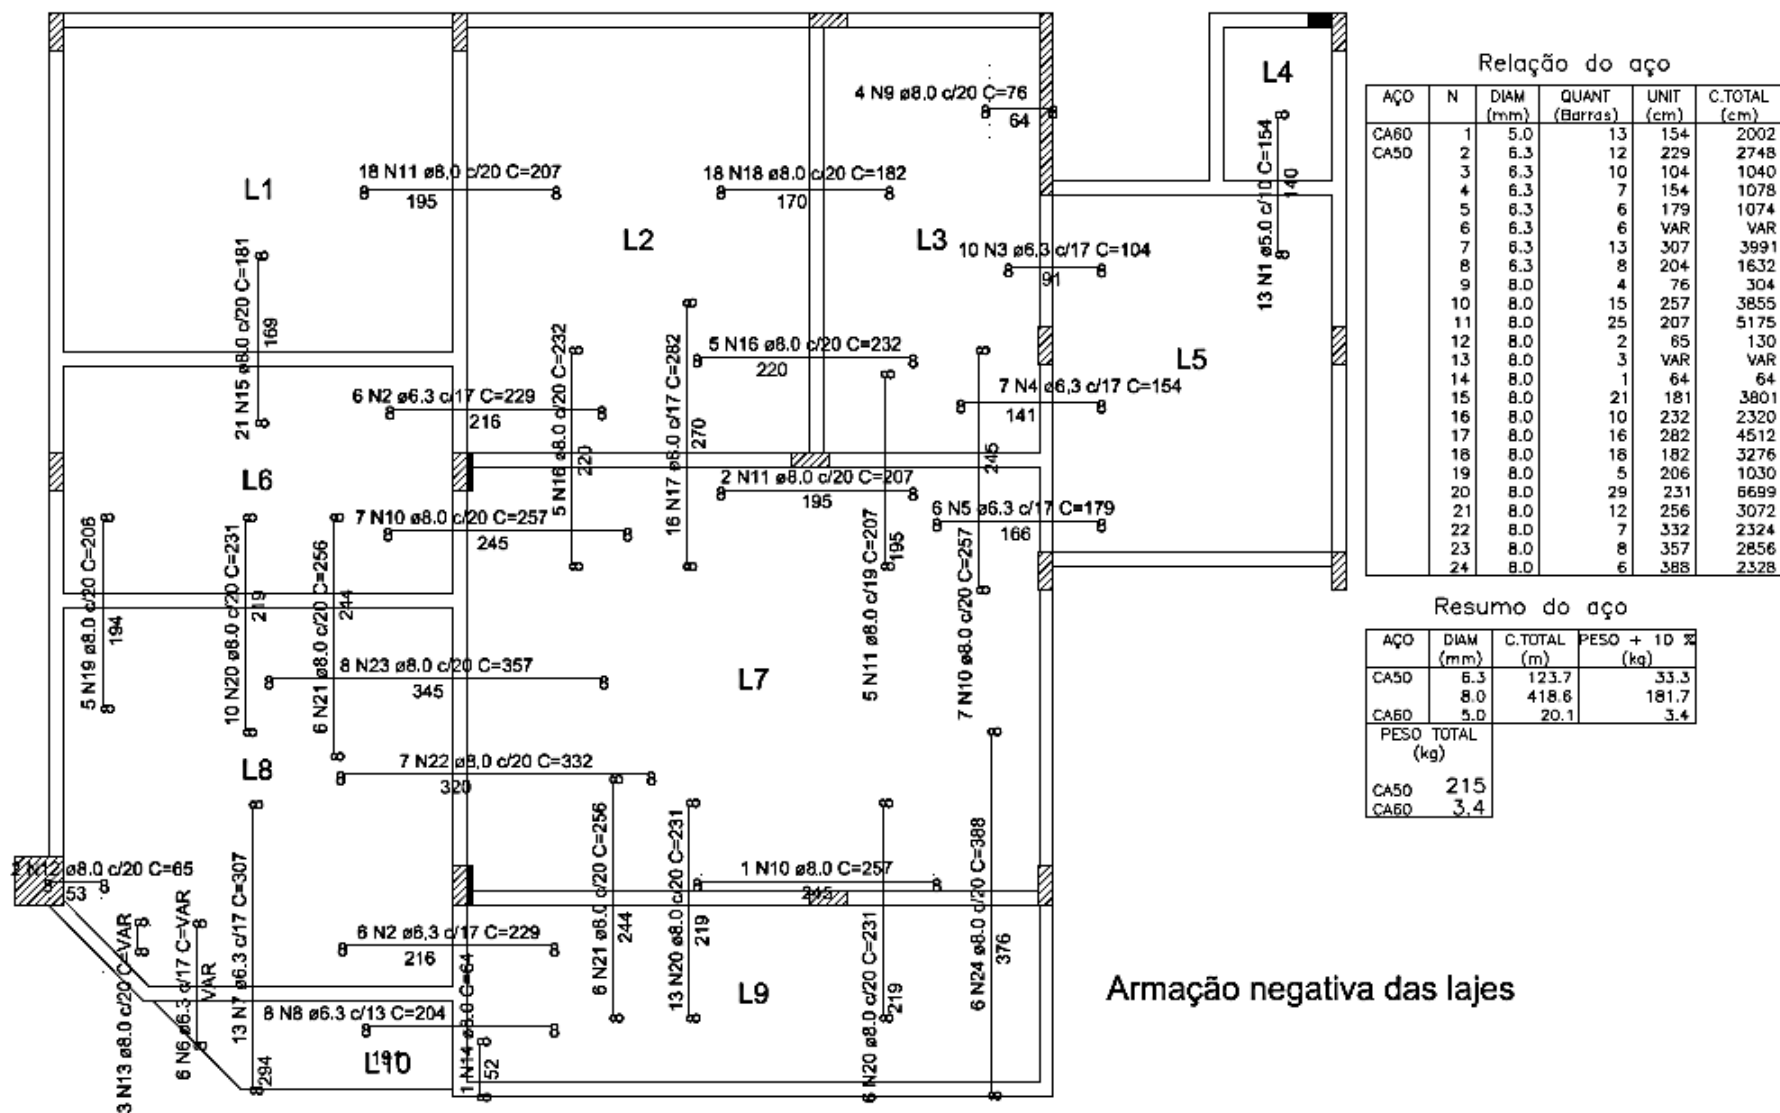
Detalhamento da armadura negativa das lajes com apoios indisolúveis mais plastificação
